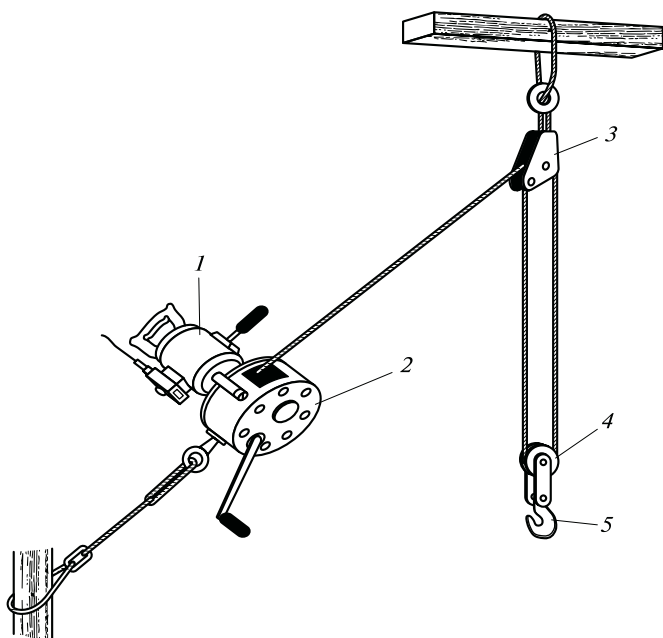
Грузоподъемное приспособление типа ППП-0,4:
